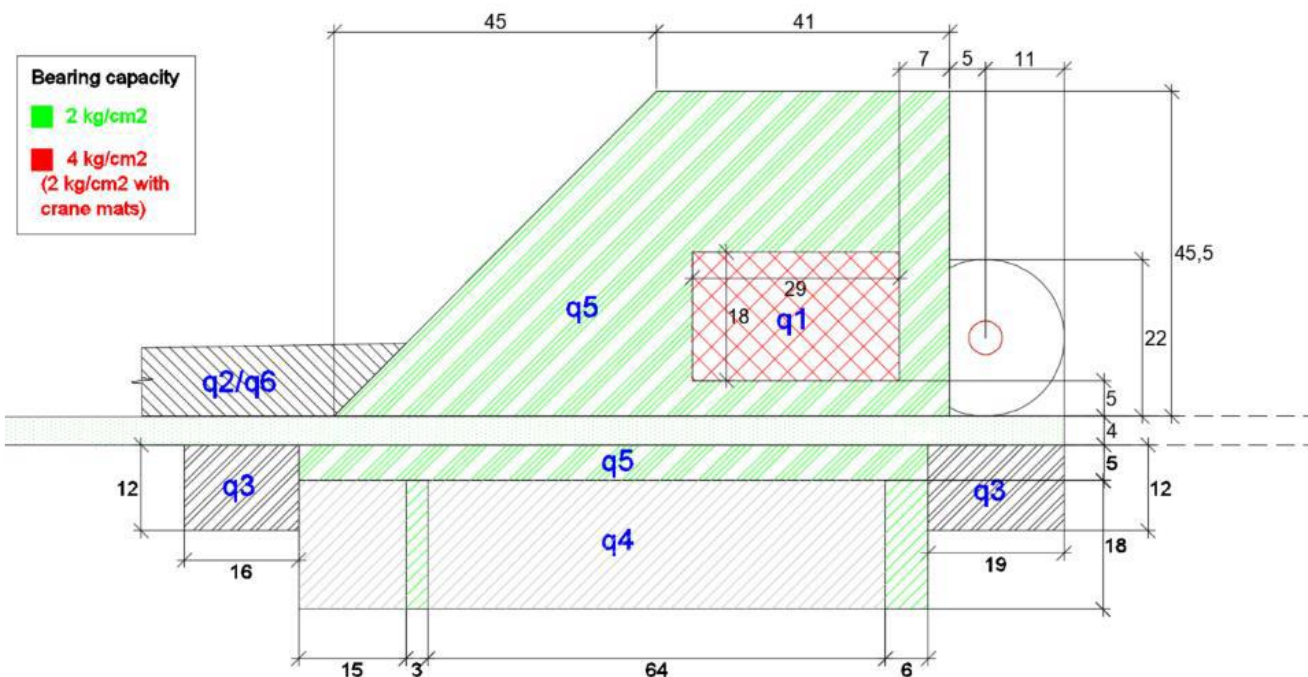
Tipico Piazzola di Cantiere o Montaggio
